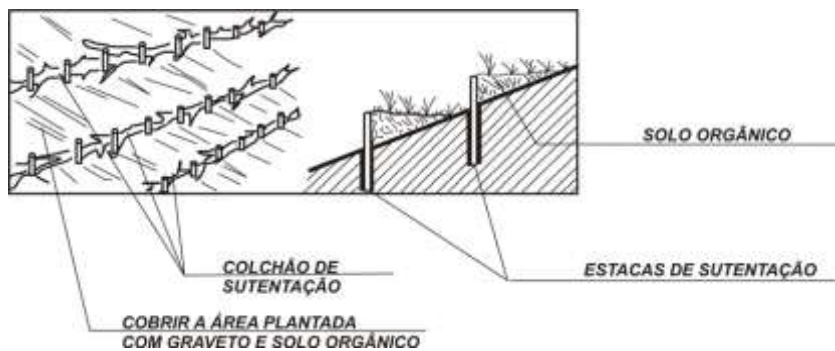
Projeto tipo 22 – Plantio em canteiros escalonados.
